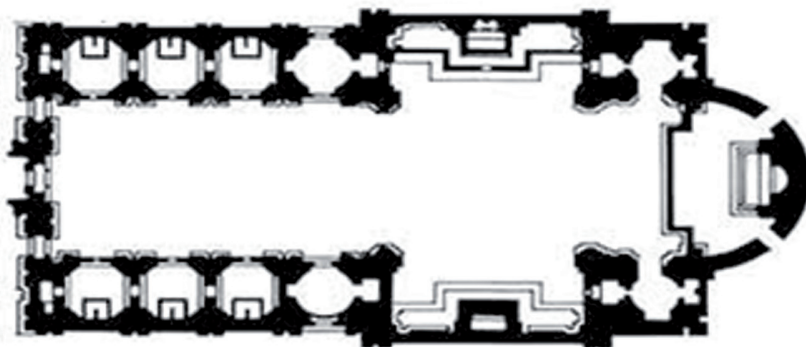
Vignola. Planta da igreja de Il Gesù, Roma.
